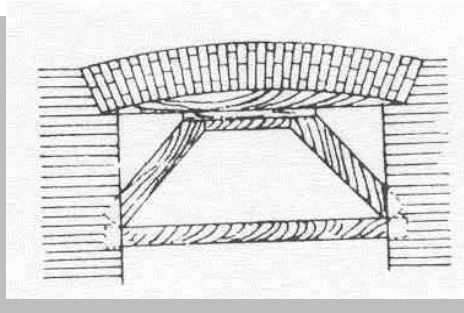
Esquema donde se aprecia el cimbrado para un arco rebajado.
